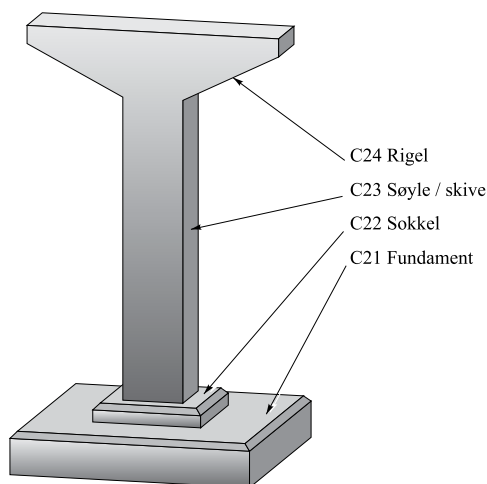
Element C2 Pilar med komponenter
